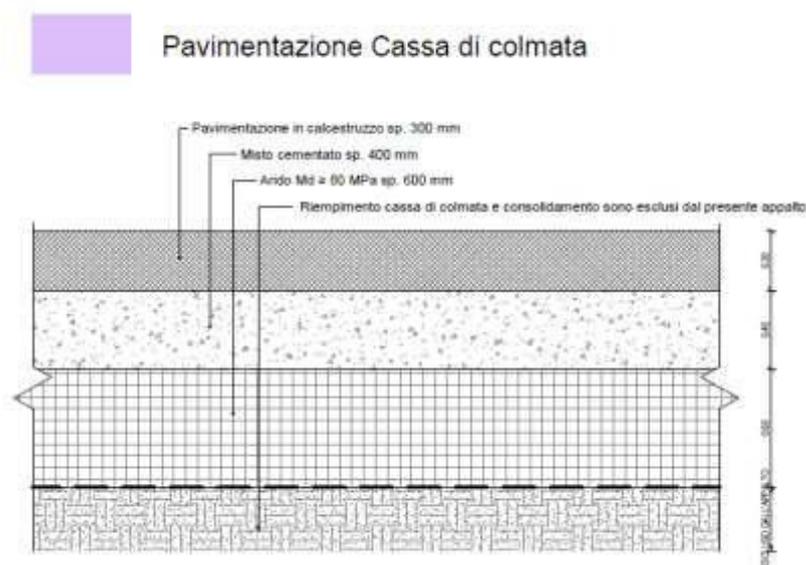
Sezione tipologica pacchetto pavimentazione nella zona della cassa di colmata (progetto Molo VIII)
